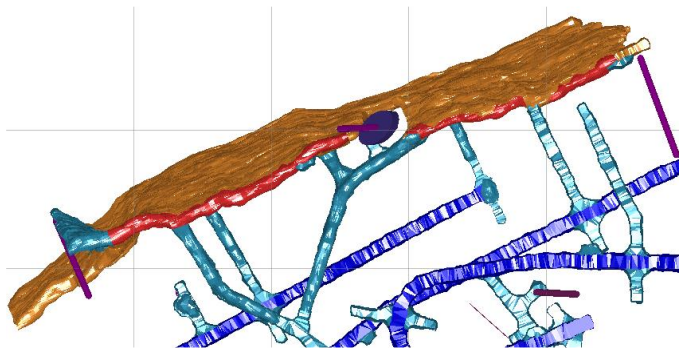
Vista en planta de rebaje 2250. (geología, 2024)
